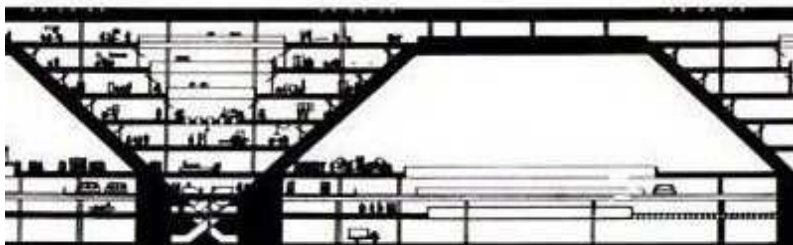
Corte esquemático de um bloco do CAE e sua conexão com outro adjacente.
